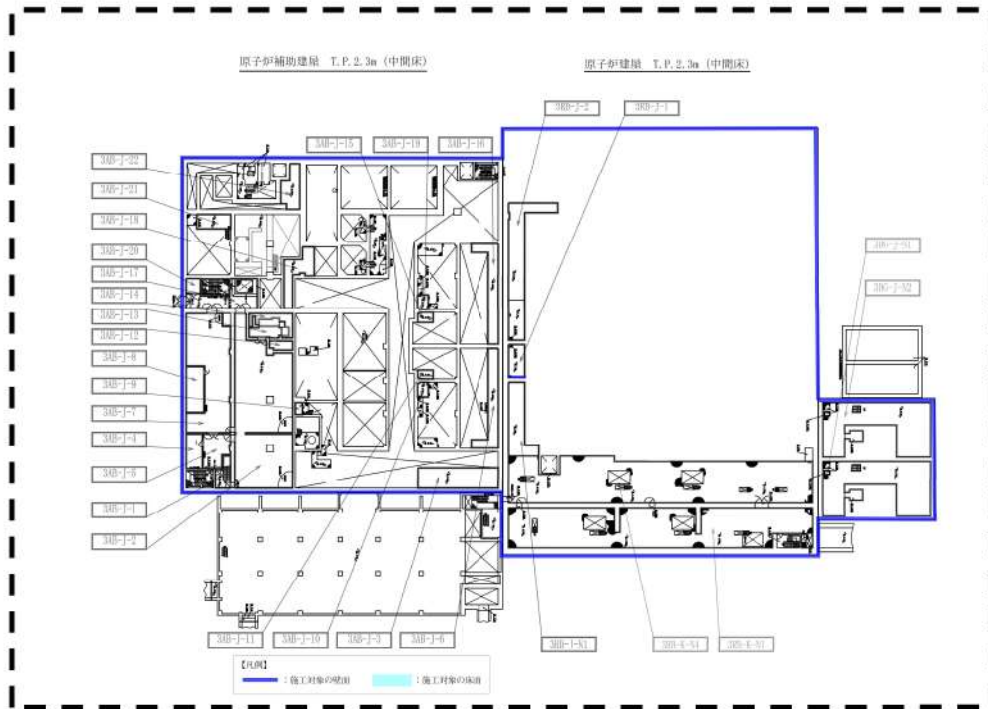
溢水防護対策施工対象の壁及び床の配置図 (8/11)
